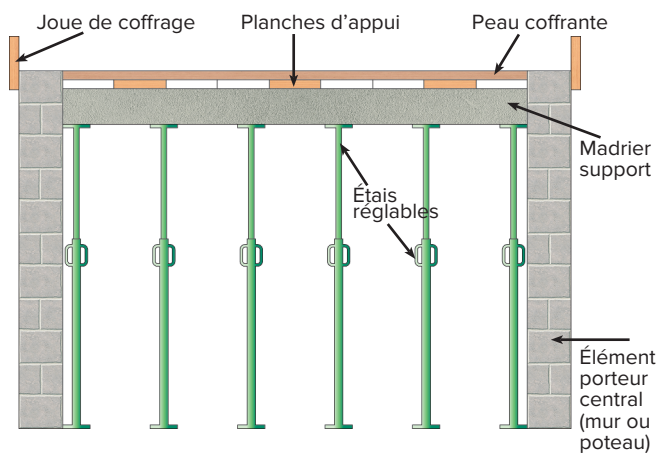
Schéma de coffrage d'un plancher traditionnel
